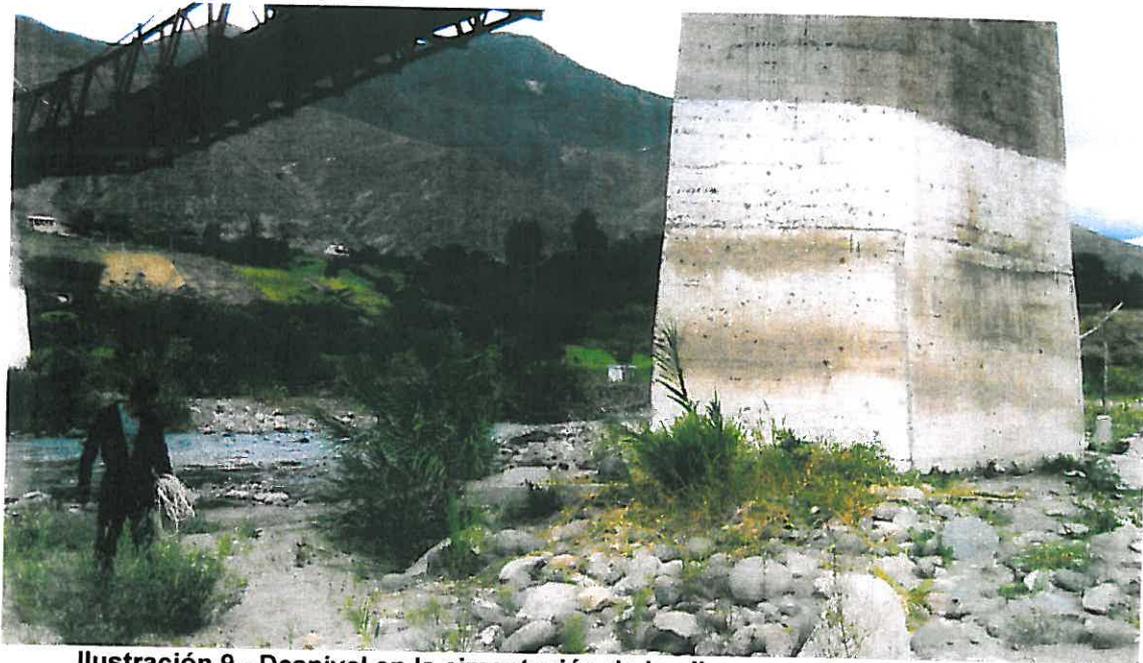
Desnivel en la cimentación de la pila generado por socavación.
